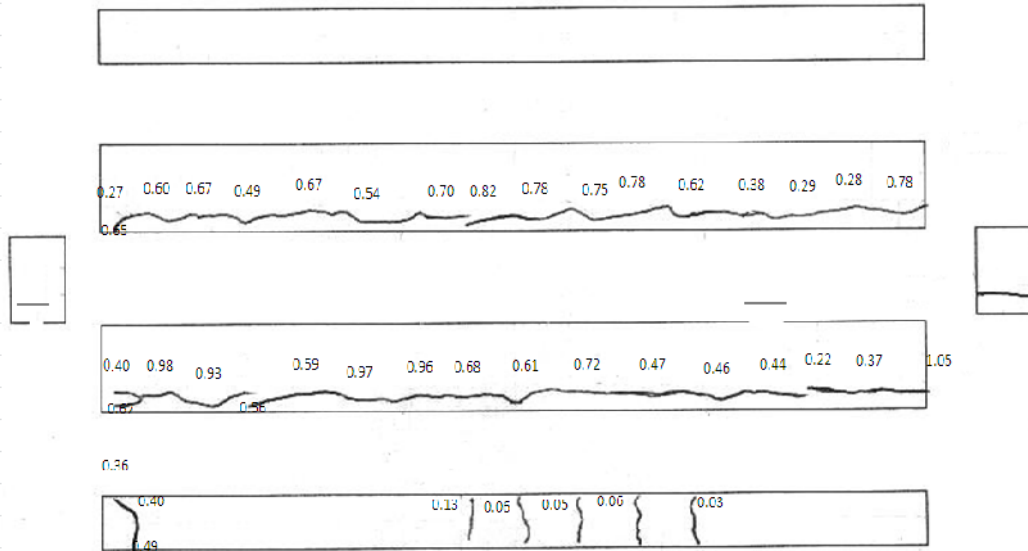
Schéma de fissuration de la poutre (3T10 20 kN) avec les ouvertures des fissures de corrosion en mm.
